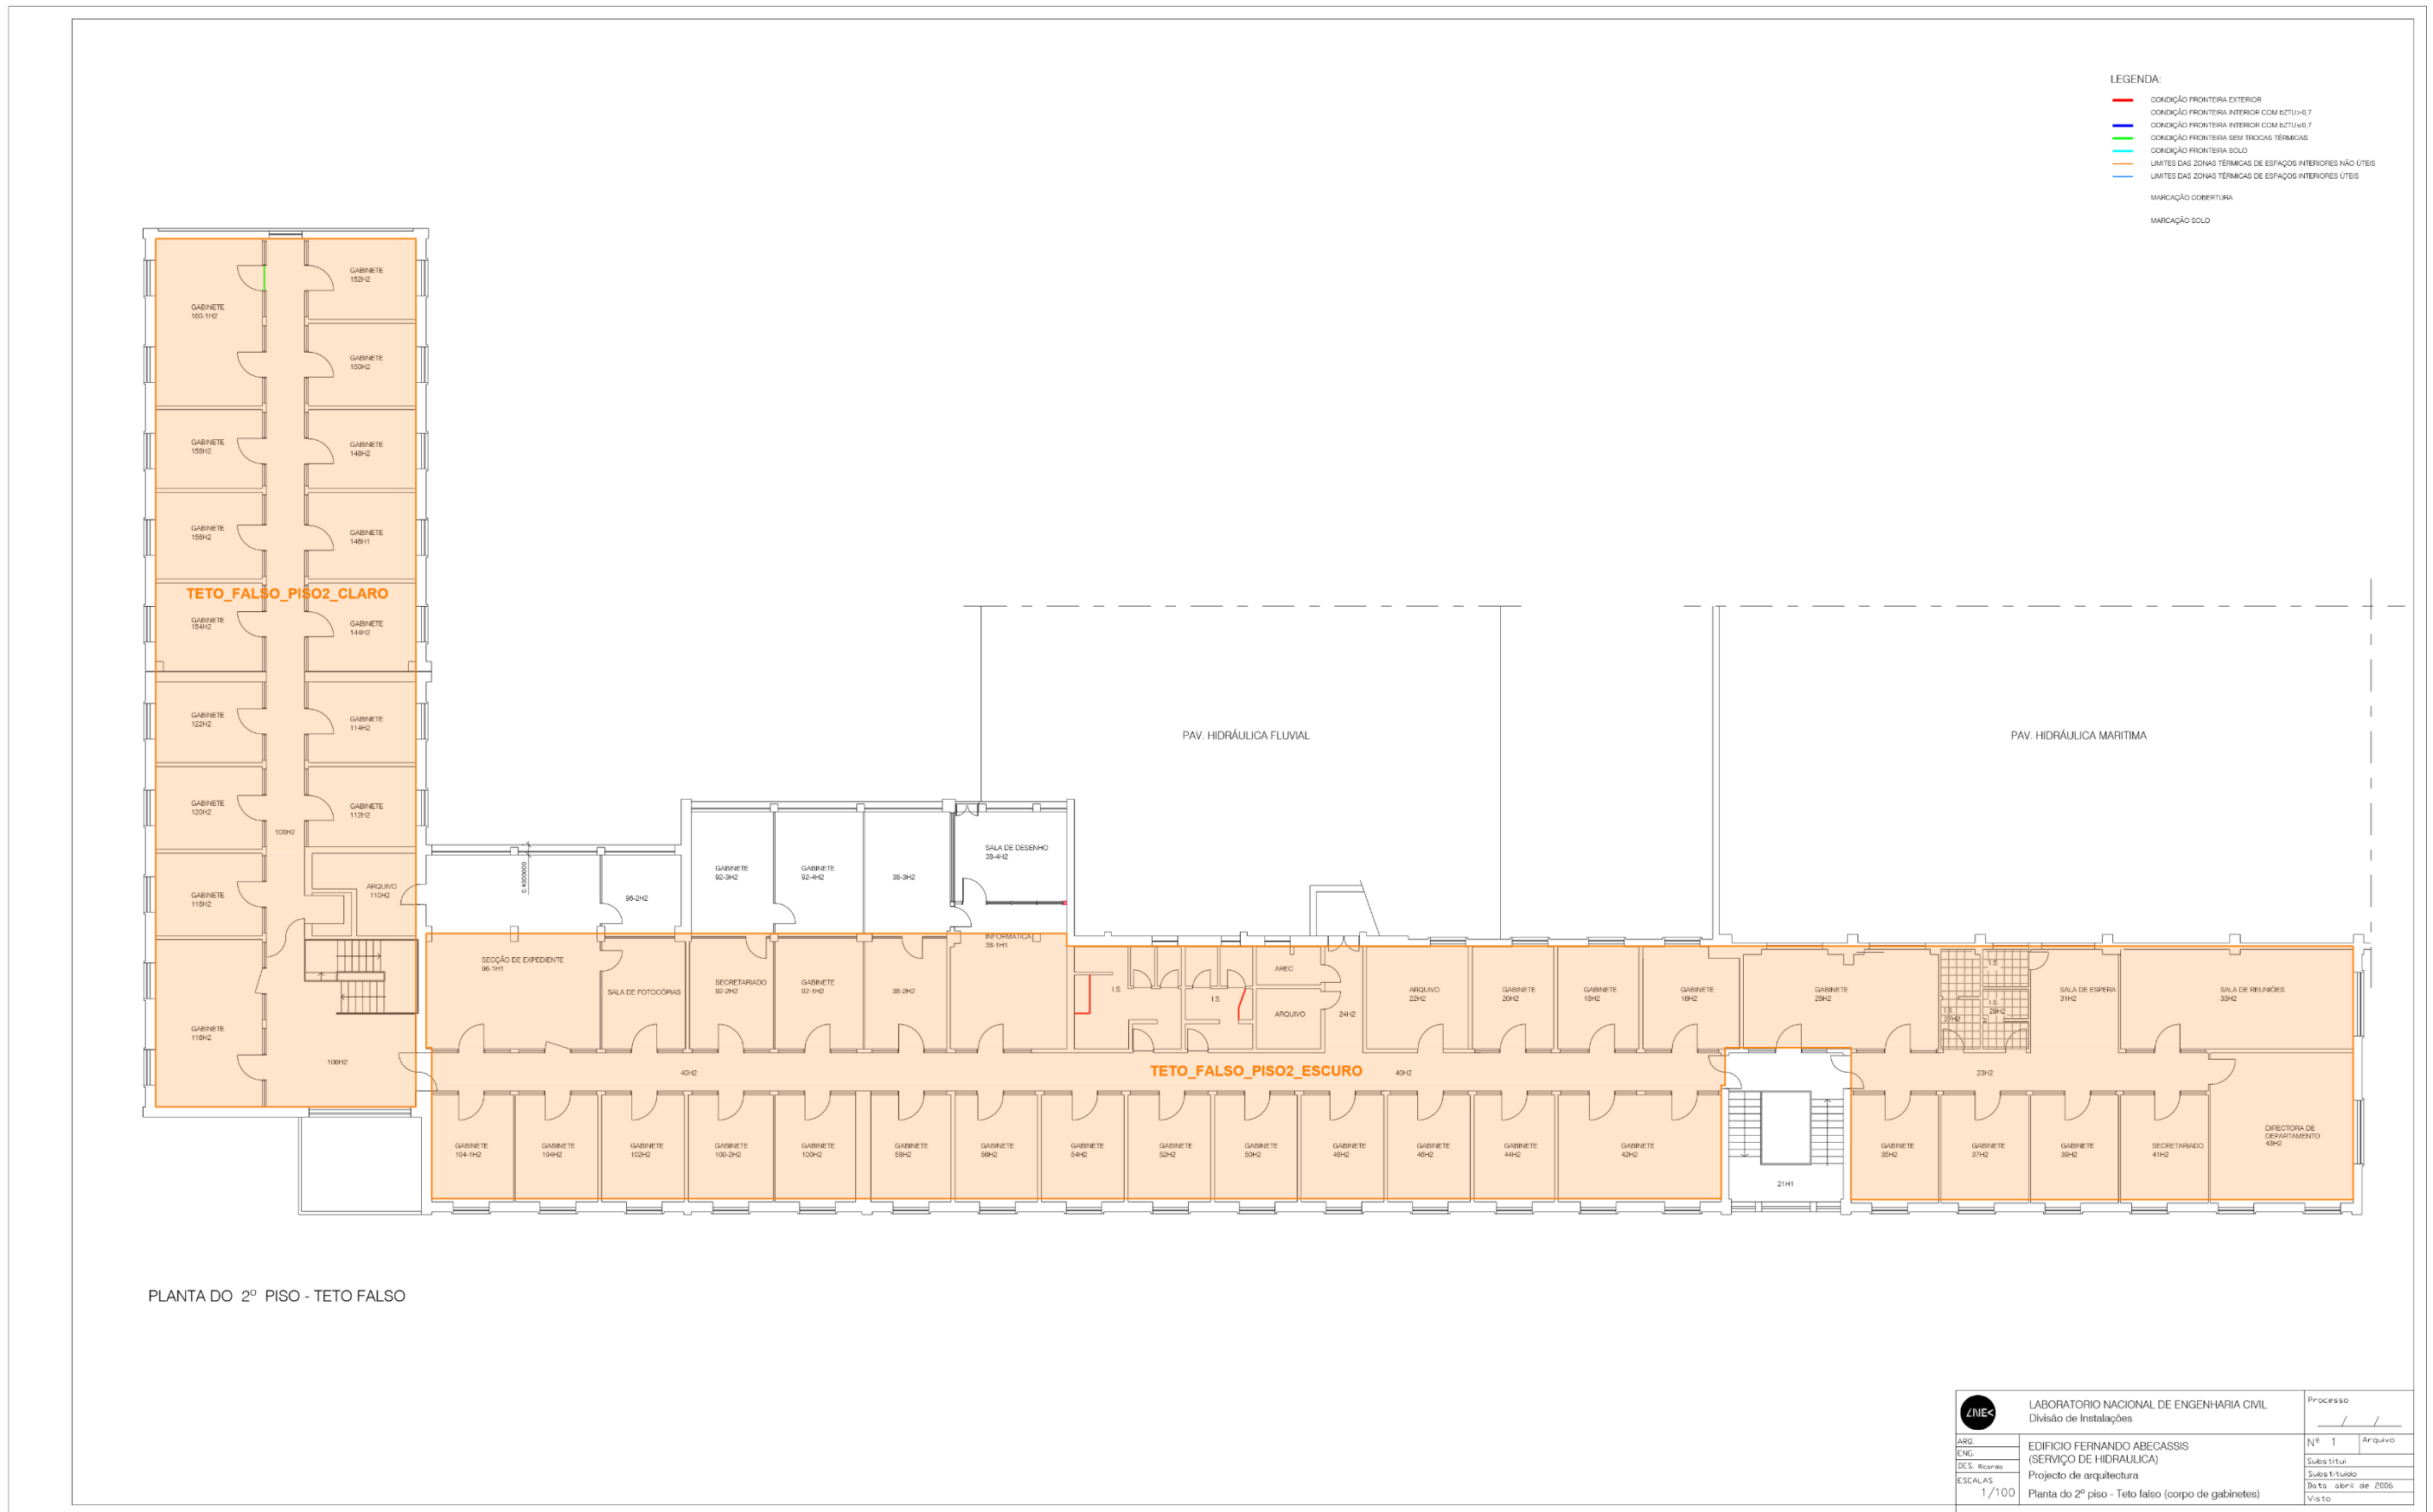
Figura – Planta do 2º Piso - Teto Falso: Identificação das zonas térmicas
